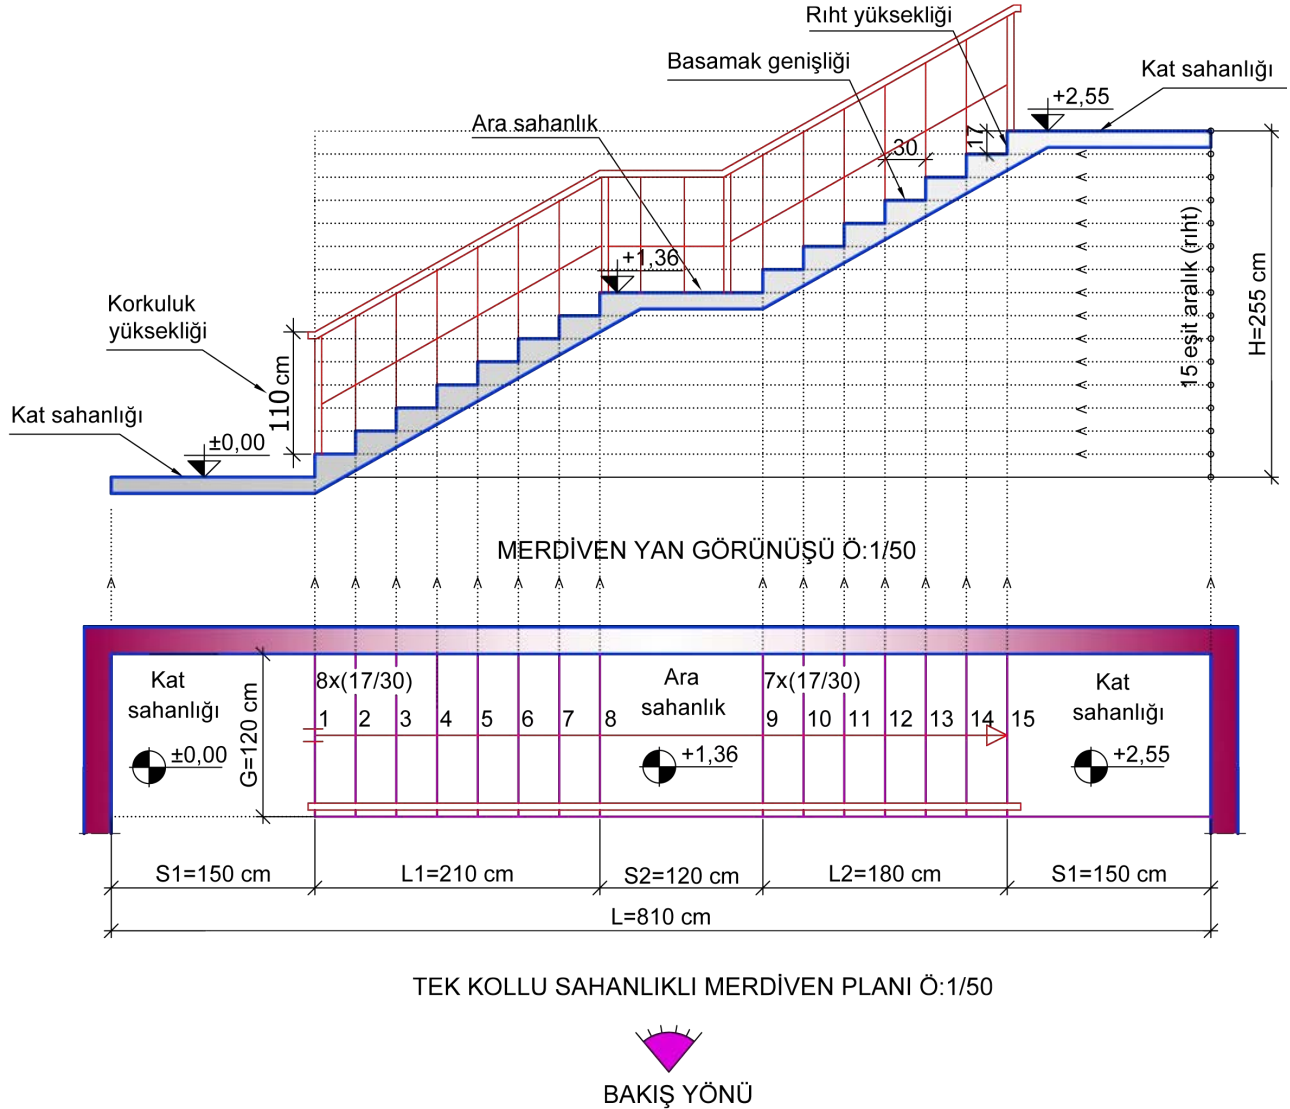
a) Tek kollu sahanlıklı merdiven taslak dengelendirme plan çizimi
